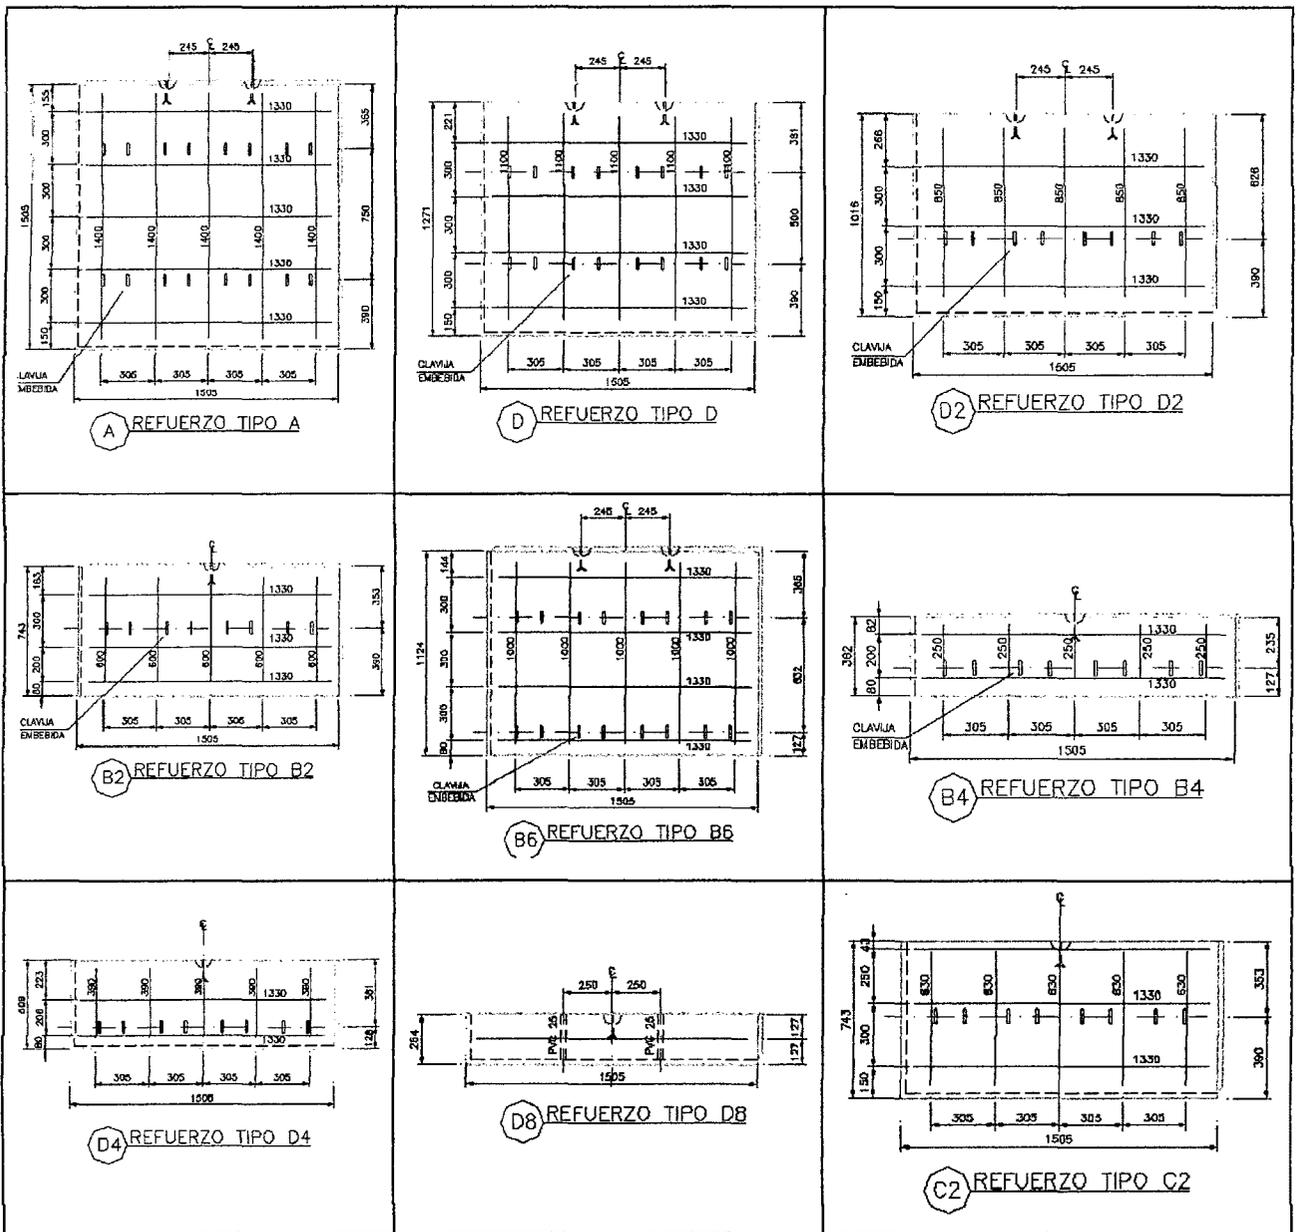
Dimensiones de los paneles a fabricar para el sistema de Muro de Tierra Retenida. Fuente: Oficina Técnica de Obra.
